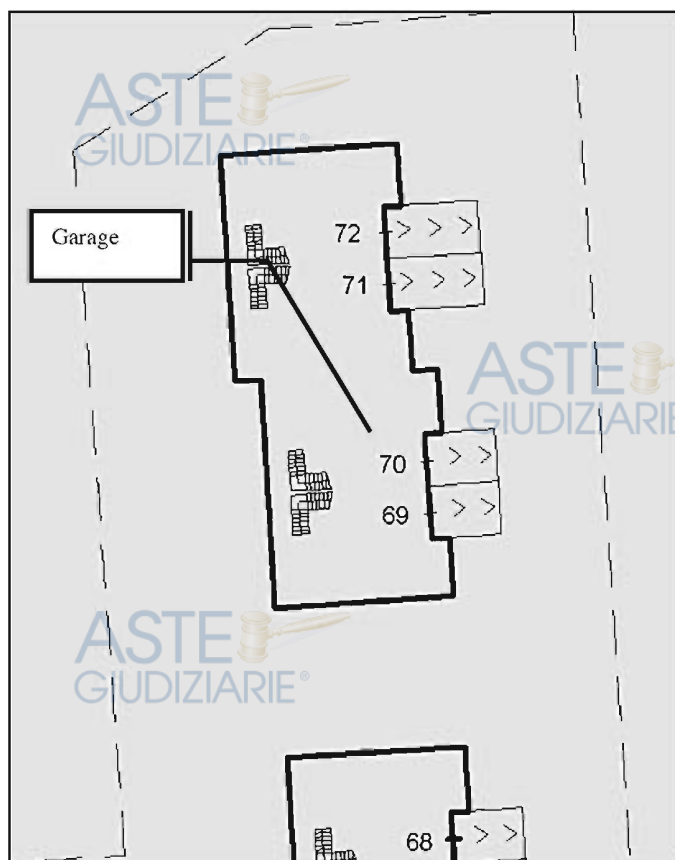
Visualizzazione dell'elaborato planimetrico del piano primo sottostrada- individuazione del sub. 70
